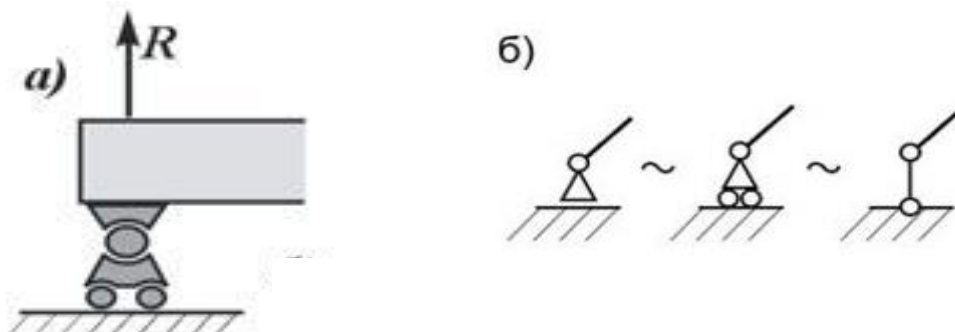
Рухомий шарнір (шарнірно-рухома опора)
